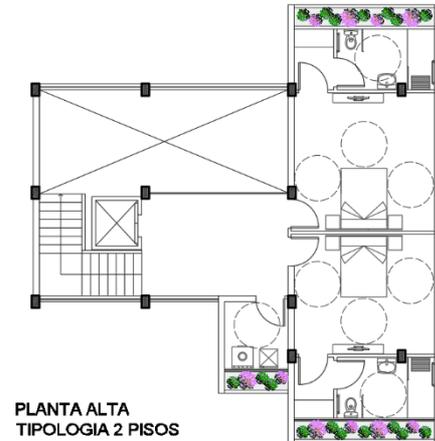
Planta alta tipología casa de 2 pisos. (Vinueza, B.)
